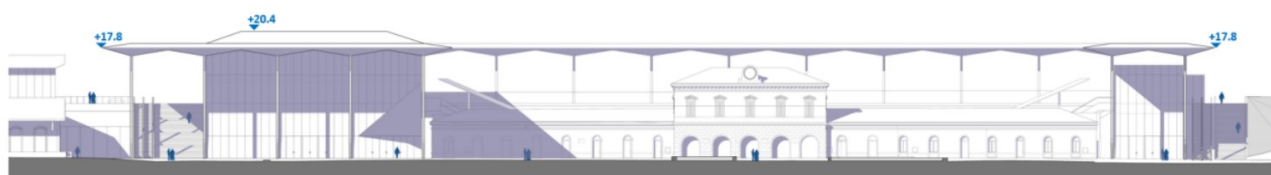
Prospetto da Piazza Marconi (Fonte: Lista di controllo)
